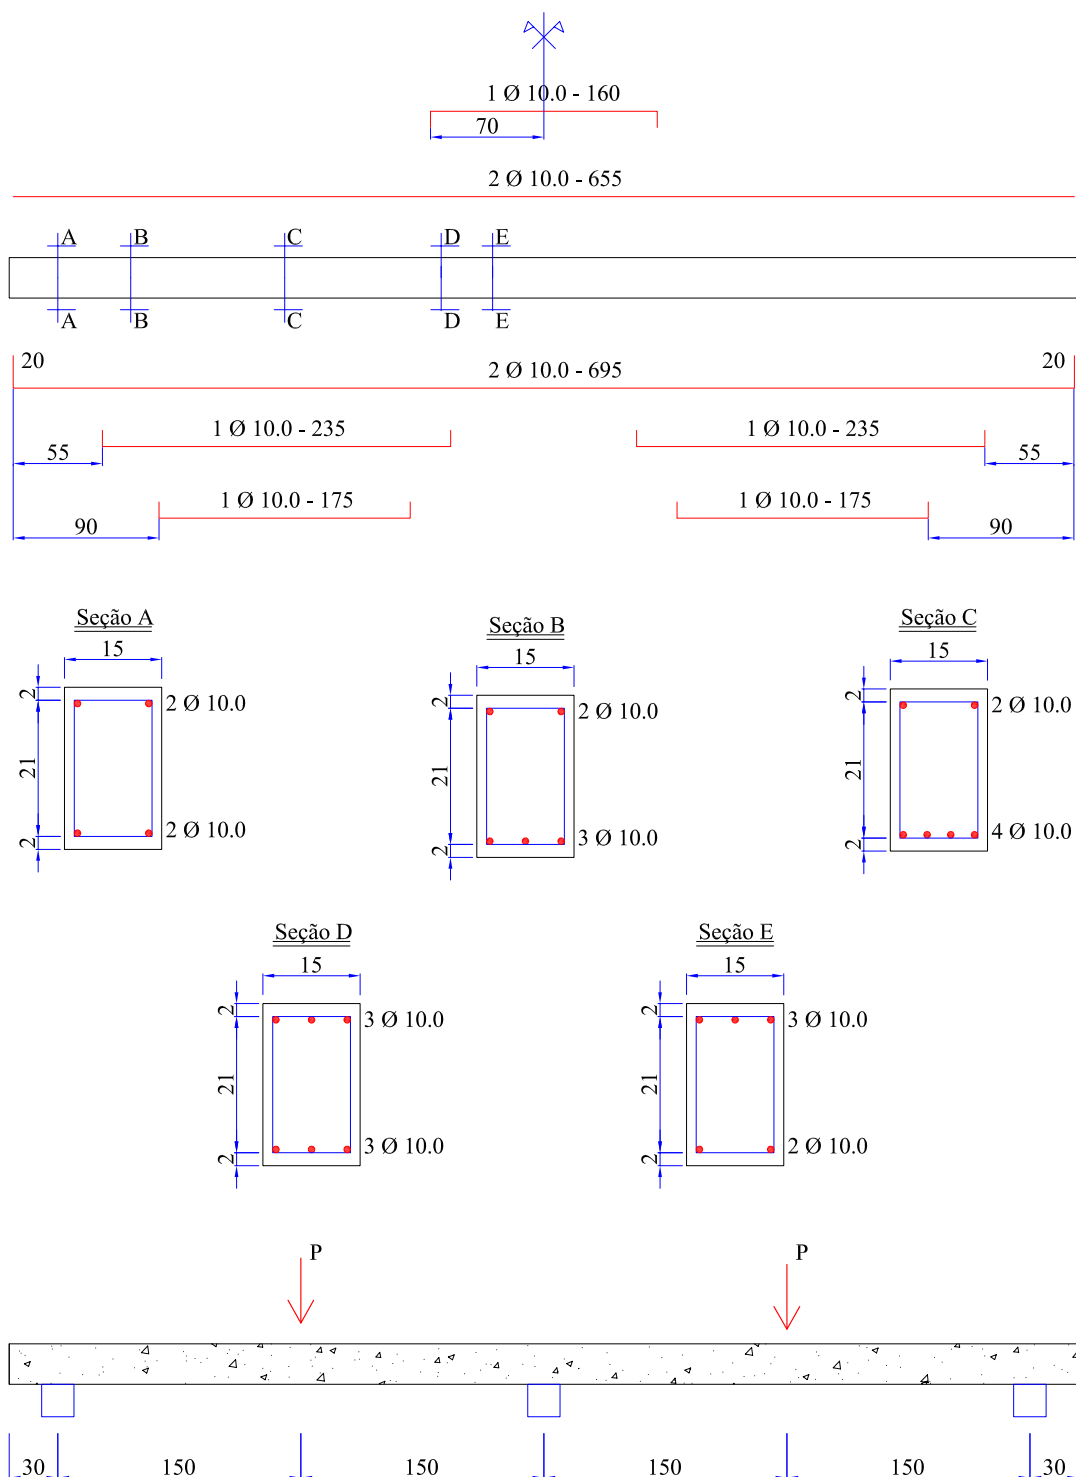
Detalhes da geometria, carregamento e armaduras da viga de Silva (1977).
